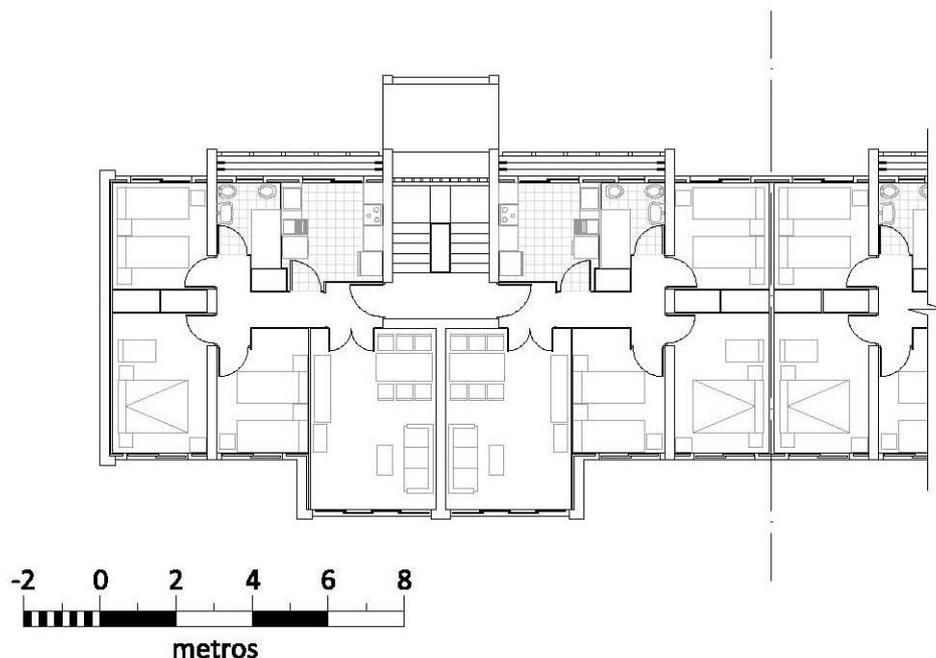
Plano de planta tipo escalera 1. Escala 1:200
